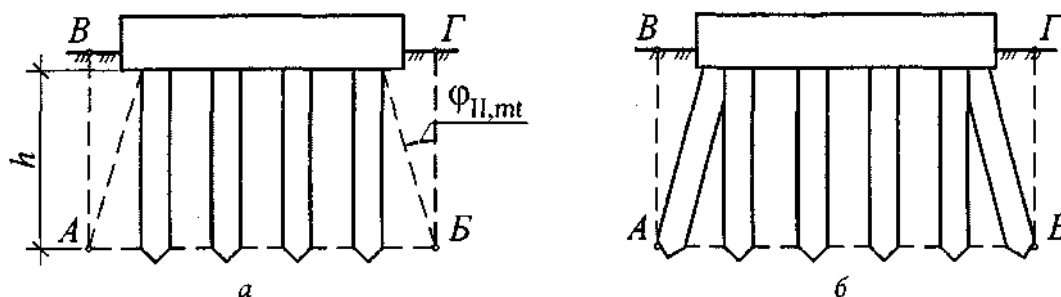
Визначення границь умовного фундаменту при розрахунку осідань пальових фундаментів
